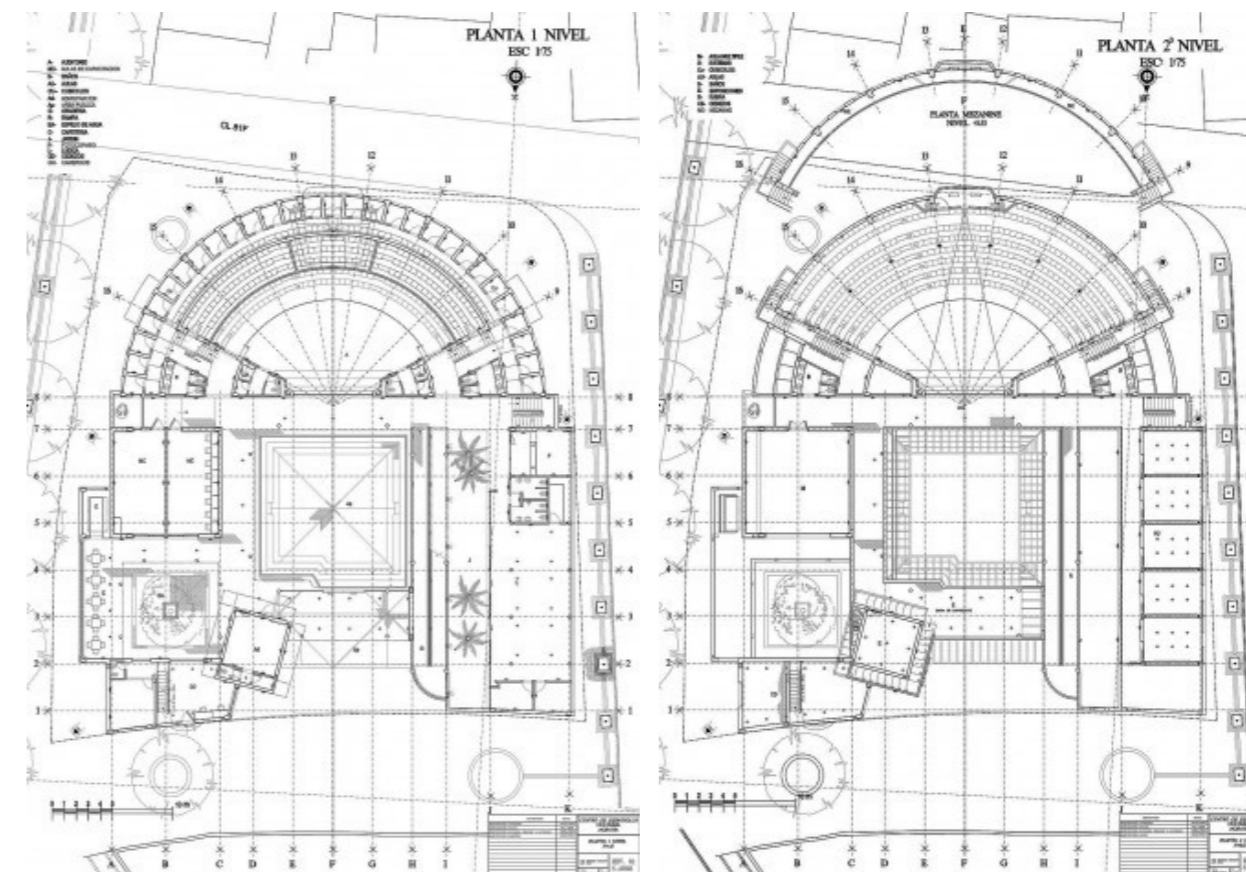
E 58 - PLANTAS TÉRREO E PAVIMENTO SUPERIOR. FONTE: FUNDACIÓN ROGELIO SALMONA.
